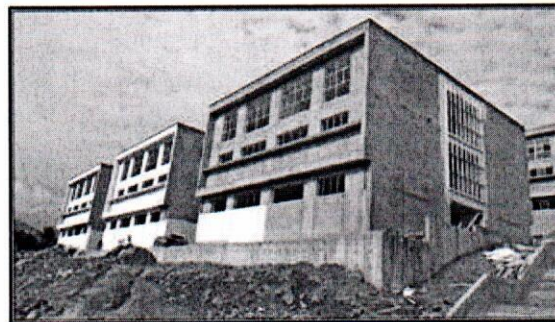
VISTA FRONTAL DE FACULTAD DE ING. MECÁNICA ELÉCTRICA
